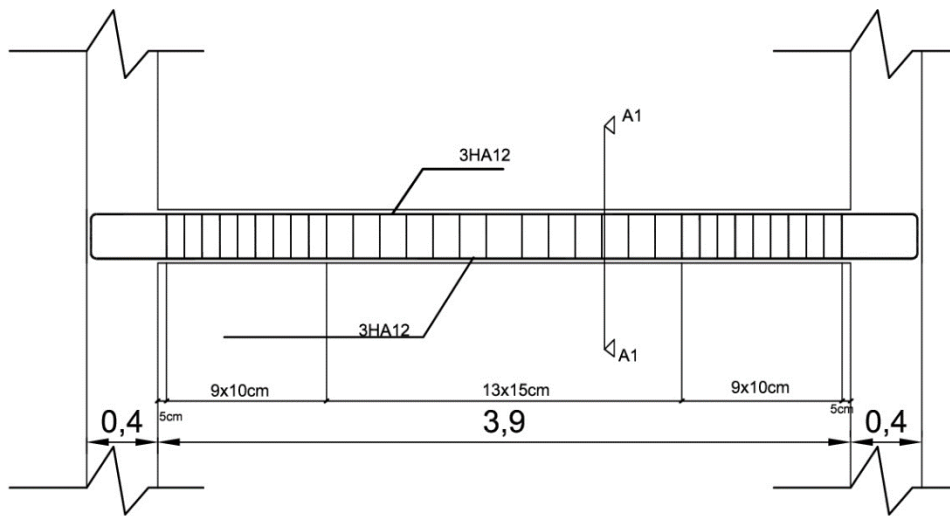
Plan de ferrailage des poutres secondaires. (PSNLV)
